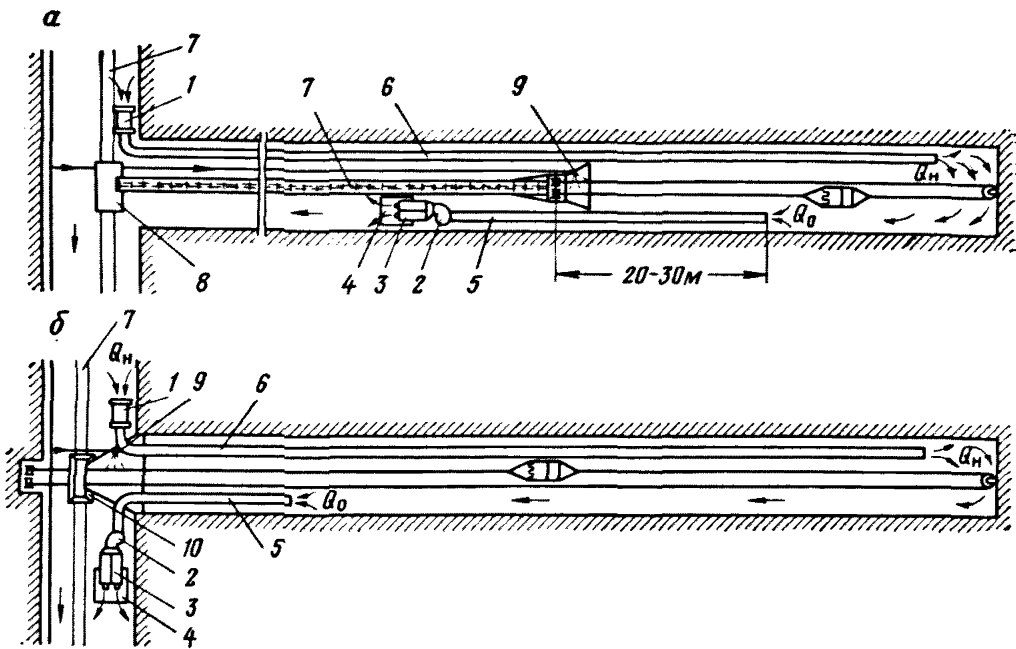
Схема пылеулавливания при транспортировании угля скреперами: а — схема с применением передвижной пылеулавливающей установки; б — схема с применением стационарной пылеулавливающей установки; 1 — вентилятор; 2 — вентилятор пылеотсасывающей установки; 3 — пылеуловитель; 4 — бак с рассолом; 5 — всасывающая труба; 6 — нагнетательный воздуховод; 7 — конвейер; 8 — укрытие перегрузочного пункта; 9 — форсунка; 10 — бункер
